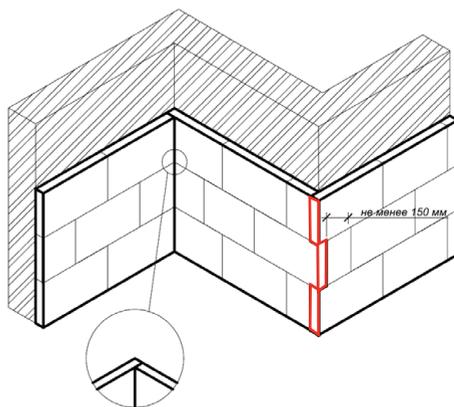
Зубчатая перевязка плит на внутренних и наружных углах здания
